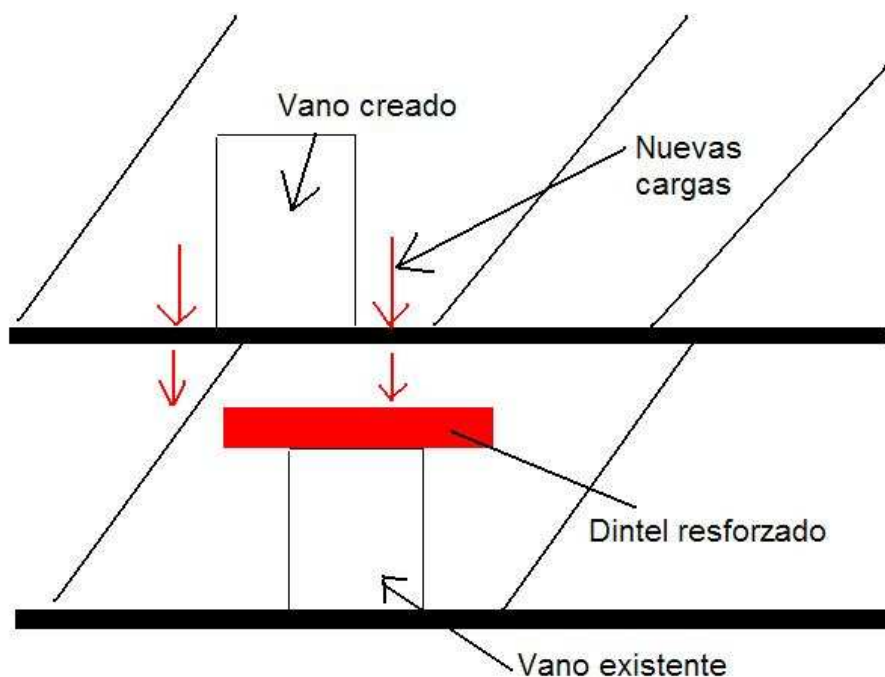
Bajada de carga modificada y influencia sobre la estructura existente
